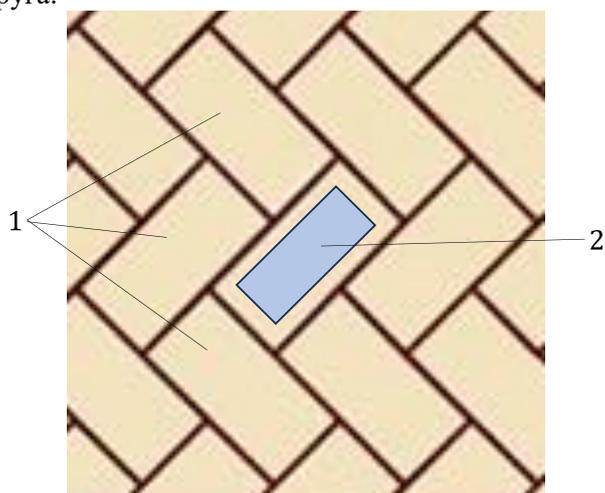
Схема укладки тротуарных плиток: 1 – тротуарные плитки, 2 – расчетная площадка для нагружения
